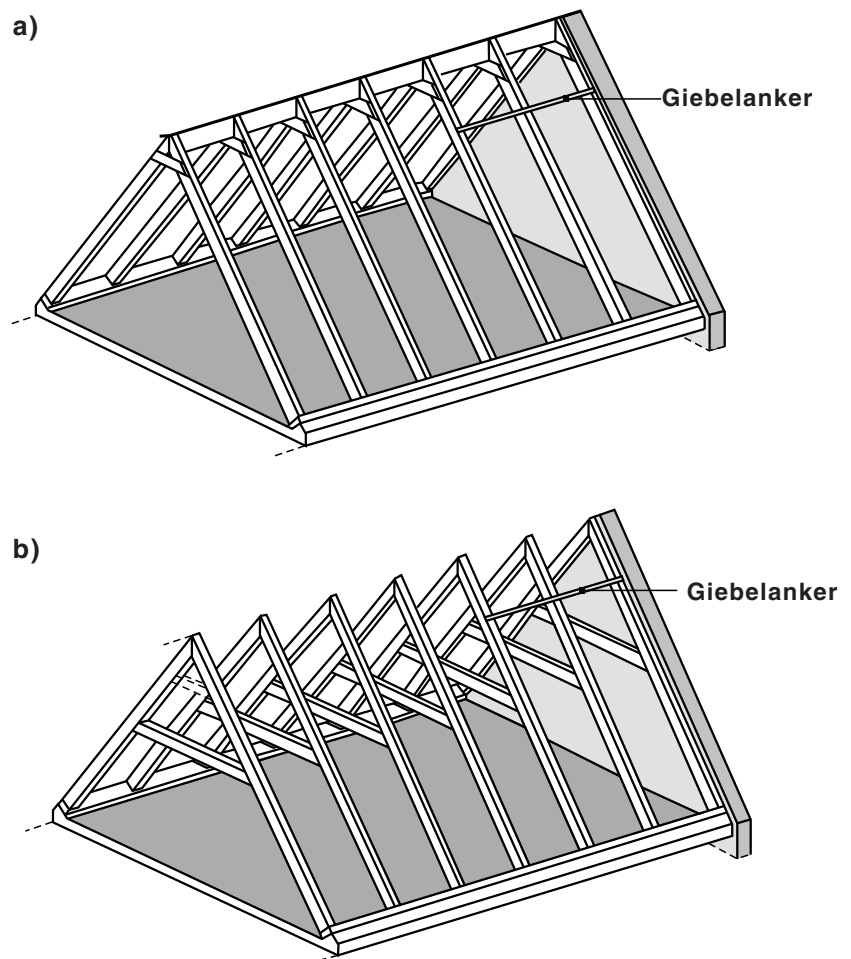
Nichttragende Giebelwände nach [13] a) Sparrendach b) Kehlbalkendach
